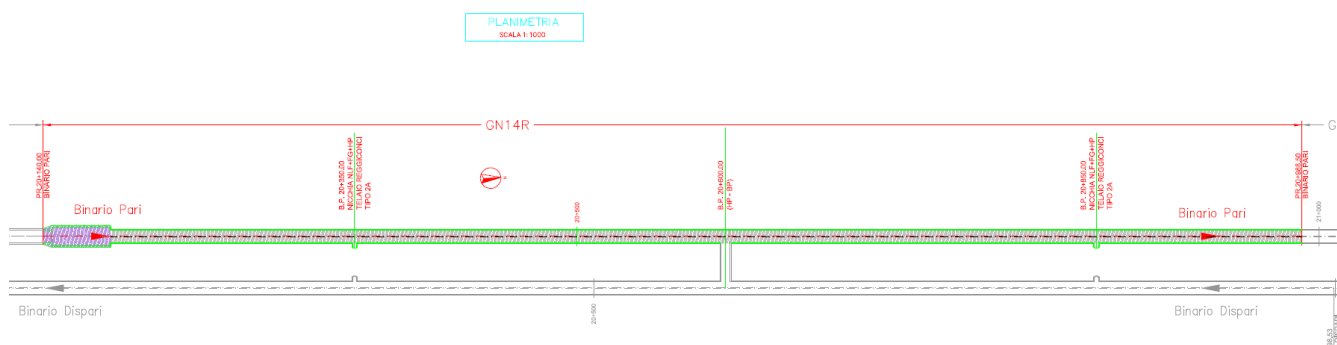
Planimetria scavo meccanizzato – WBS GN14R
